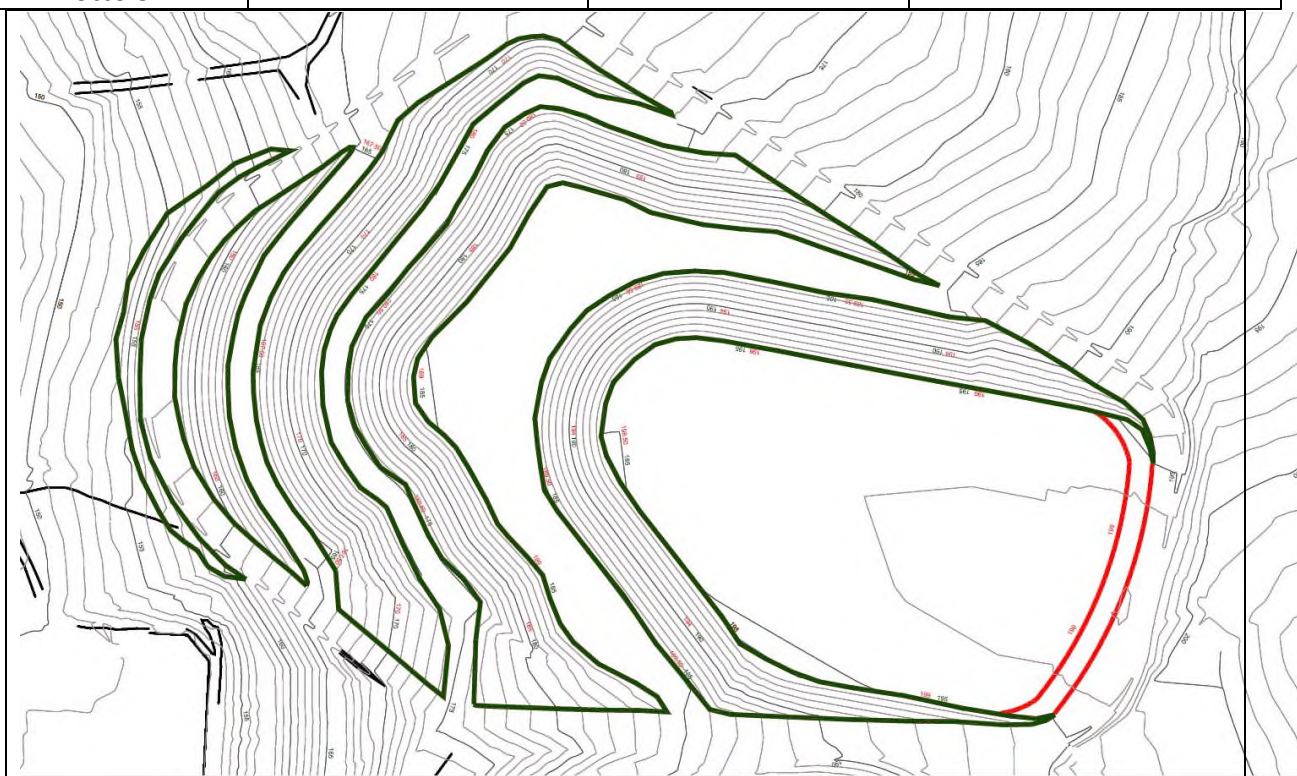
Stralcio planimetria confronto ripristino ambientale
